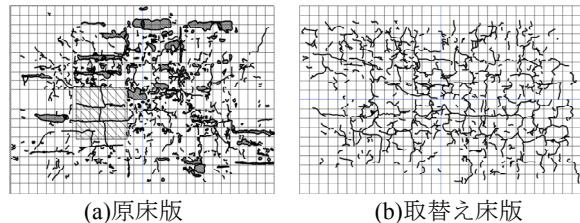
下面ひび割れの発生状況(疲労限界時)
